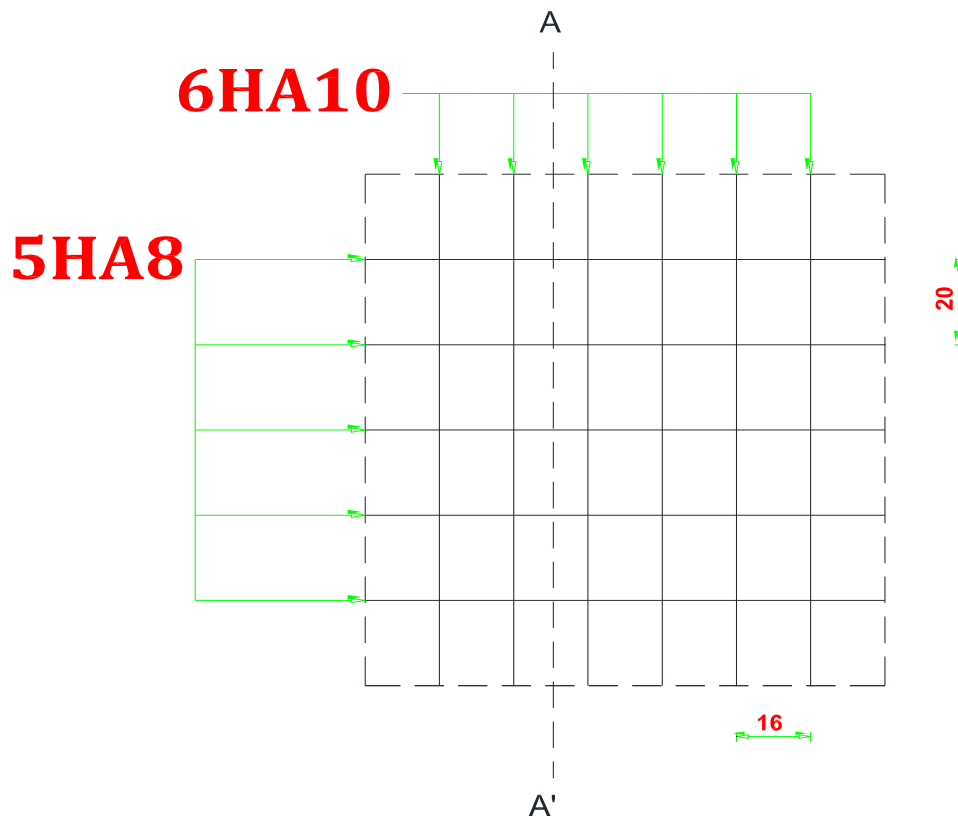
Schéma de ferrailage du voile périphérique.
